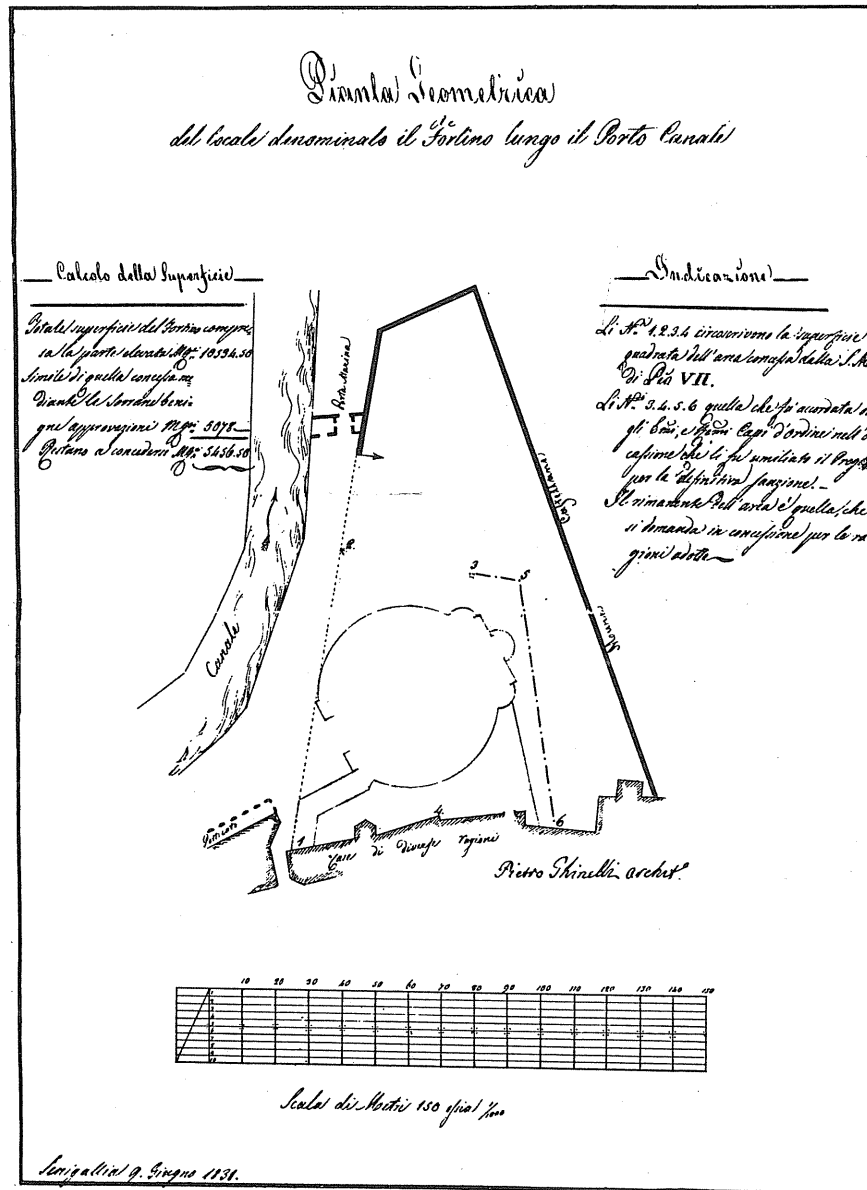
Senigallia (AN): *Foro Annonario*, progetto sferico (1831), arch. Pietro Ghinelli, planimetria generale.
